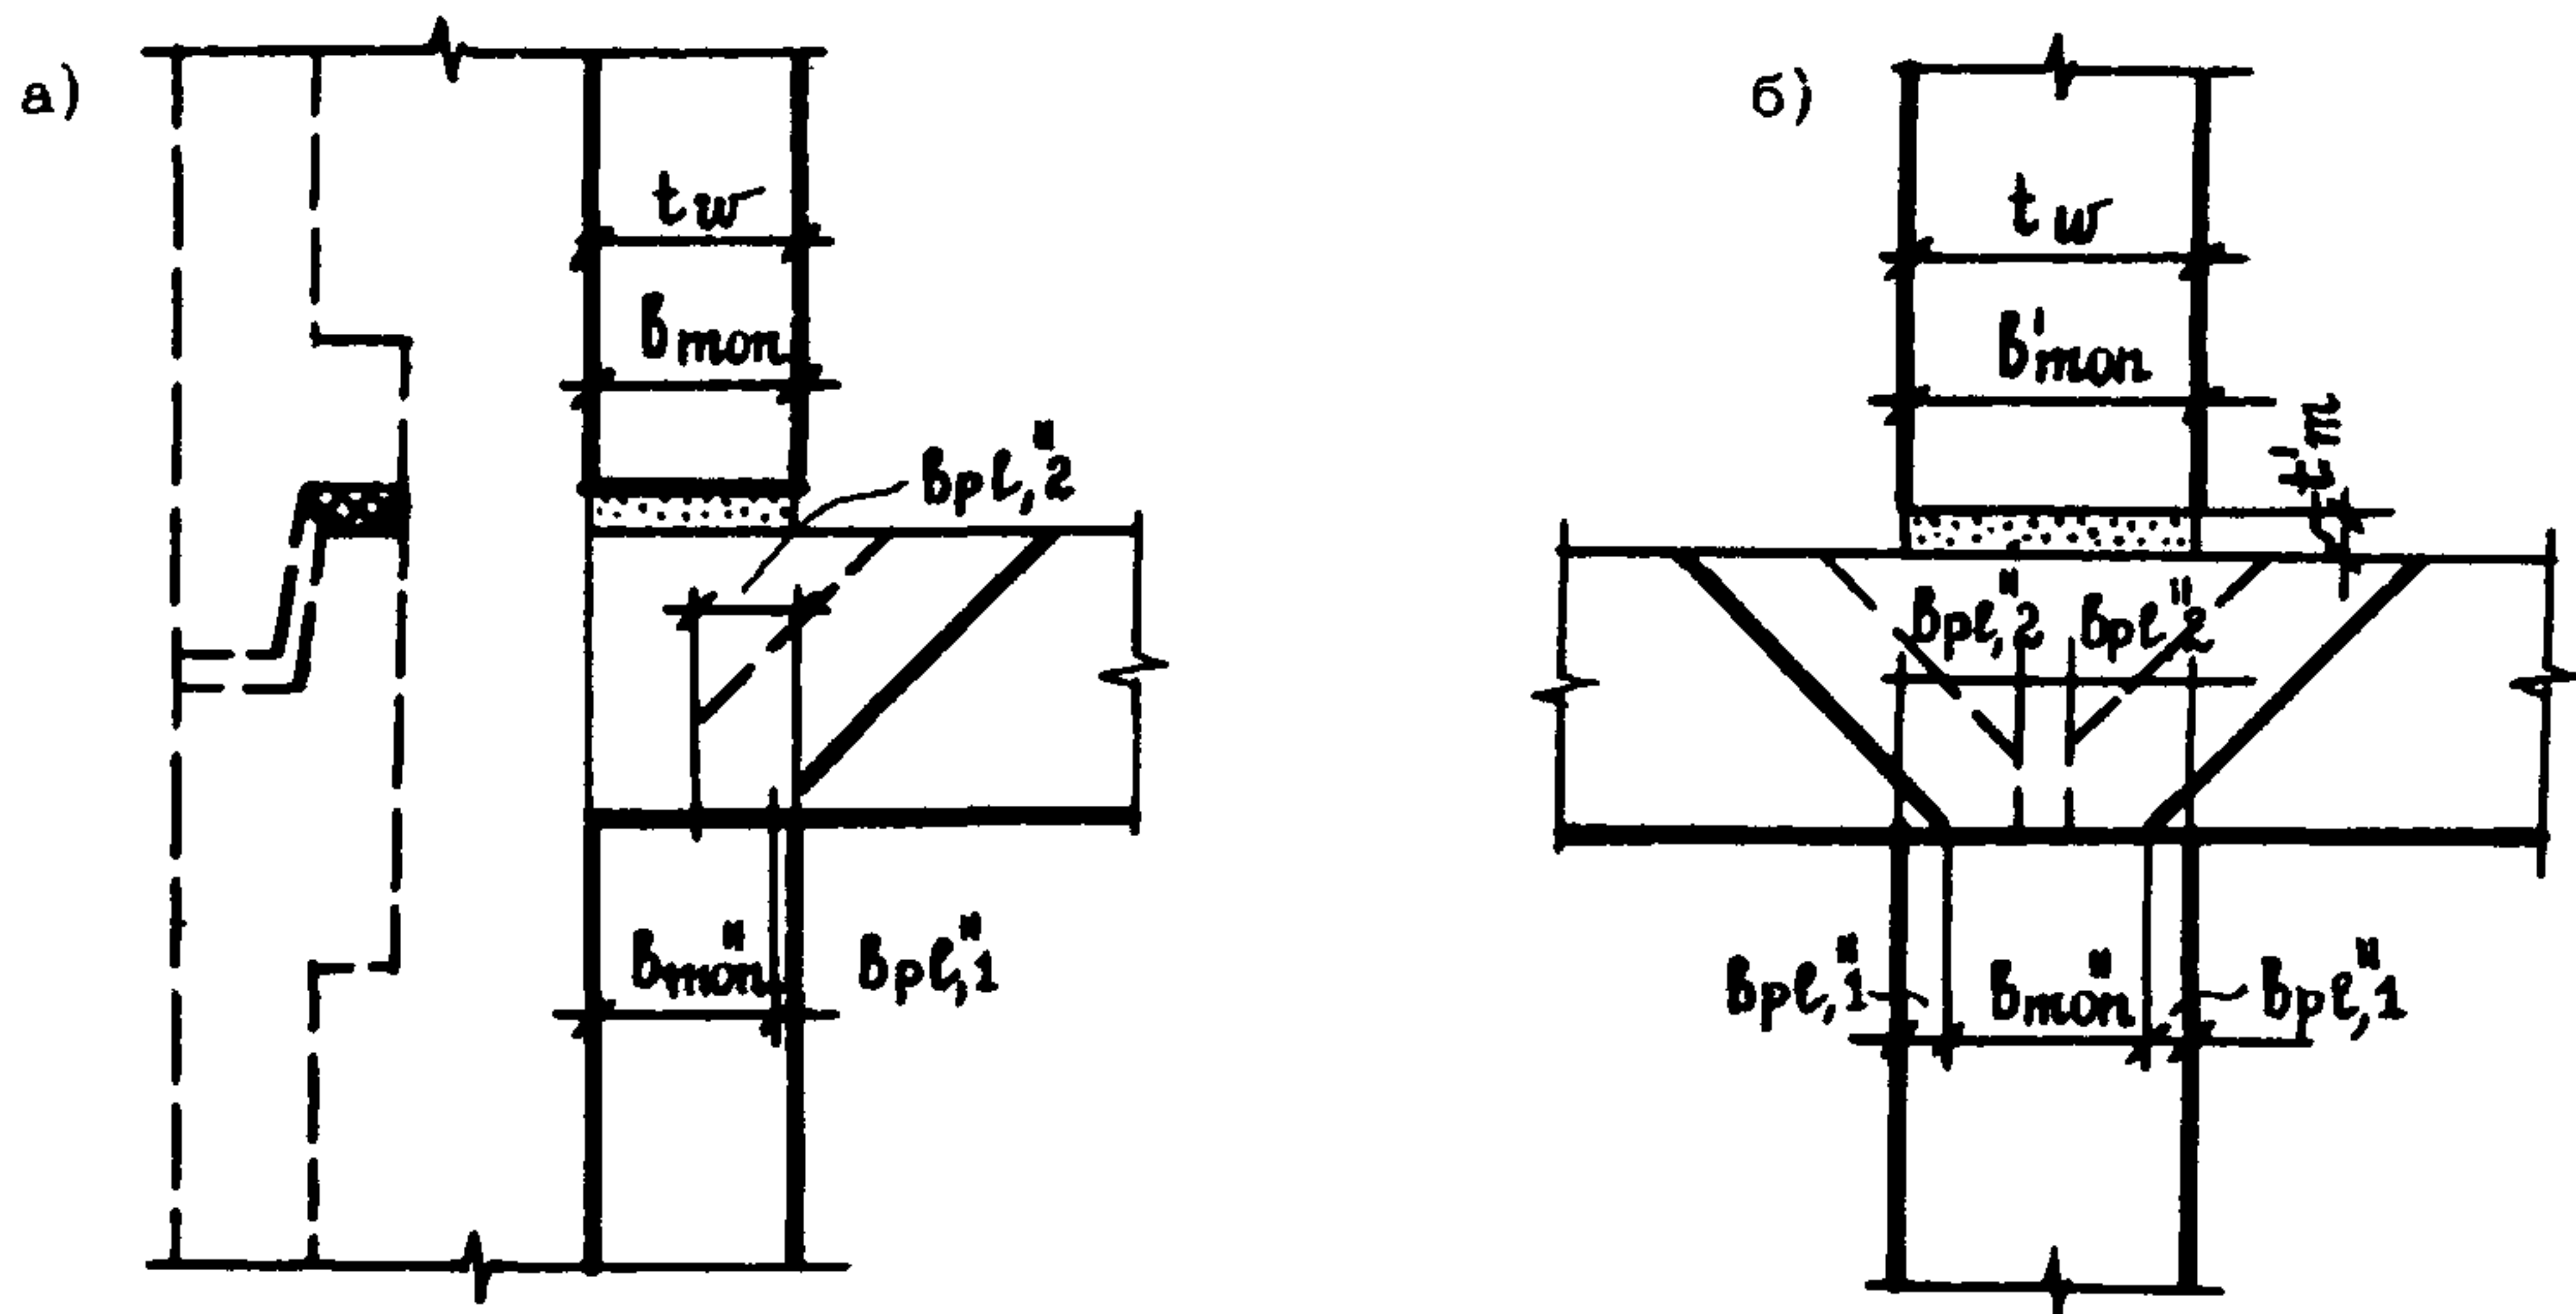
Монолитные стыки с односторонним (а) и двусторонним (б) опиранием плит перекрытий
